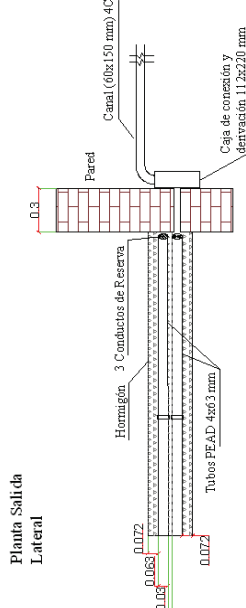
Planta salida lateral a fachada de la Red de Acceso
